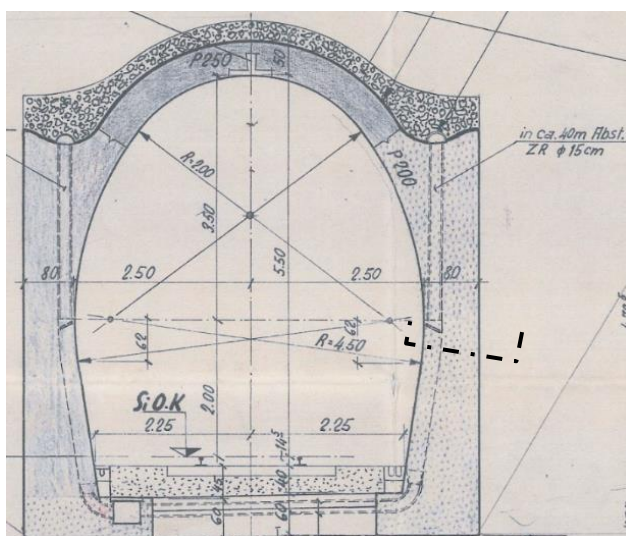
Tunnelquerschnitt (in Geraden) mit Entwässerung
